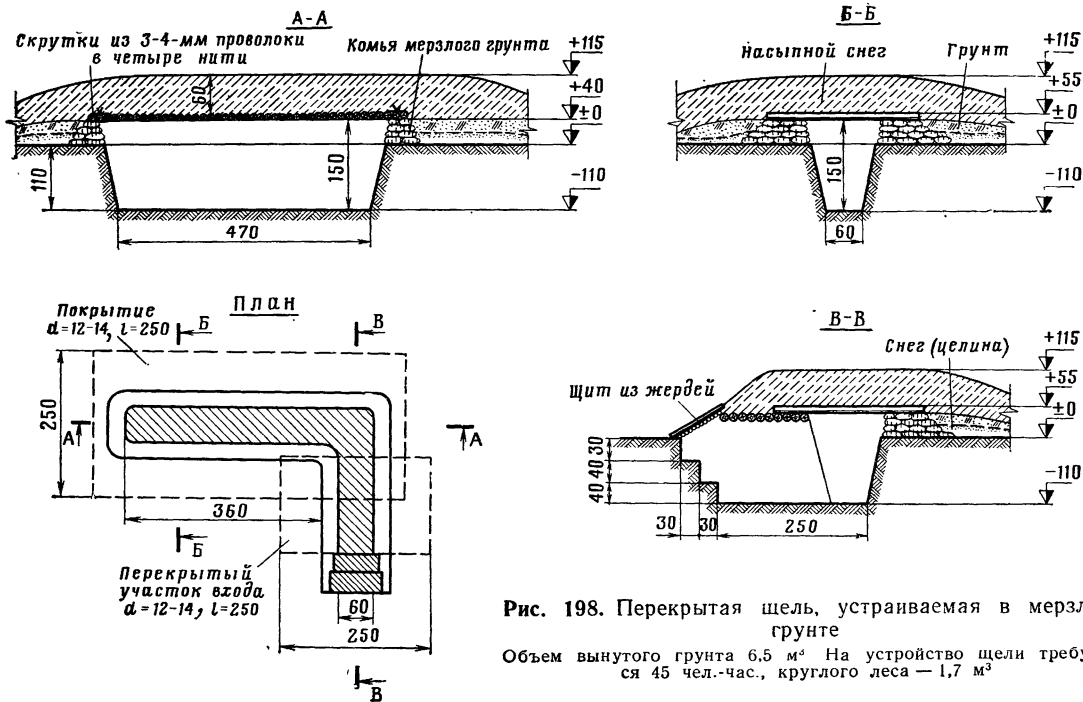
Перекрытая шель, устраиваемая в мерзлом грунте
